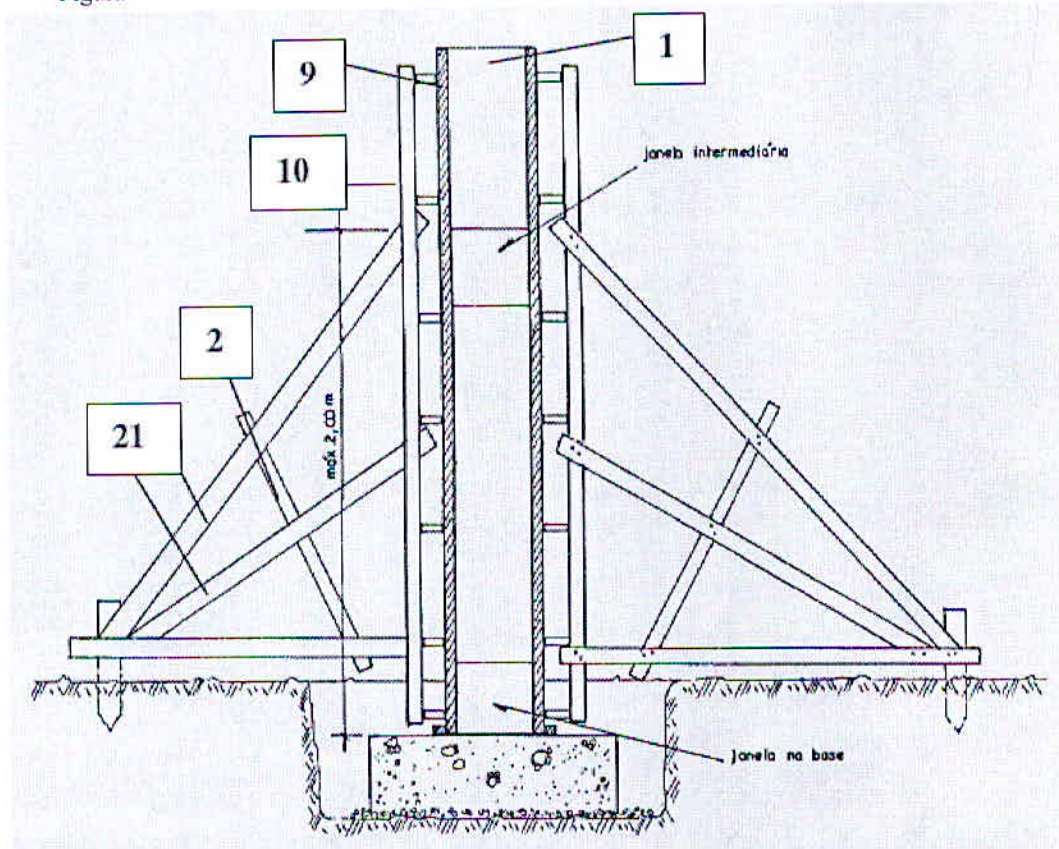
Detalhe do escoramento e contraventamento em pilares.
